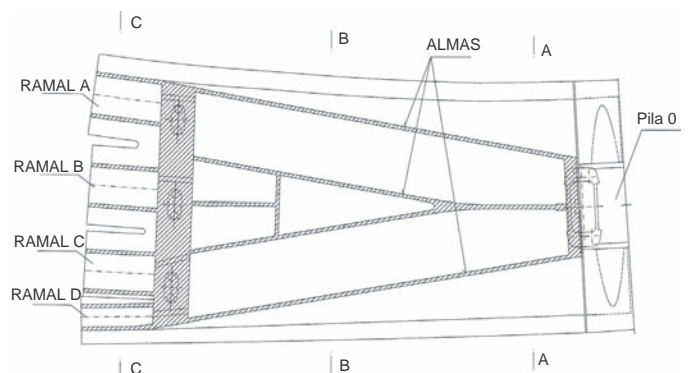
Viaducto zona de transición. Planta de las almas del tablero.
